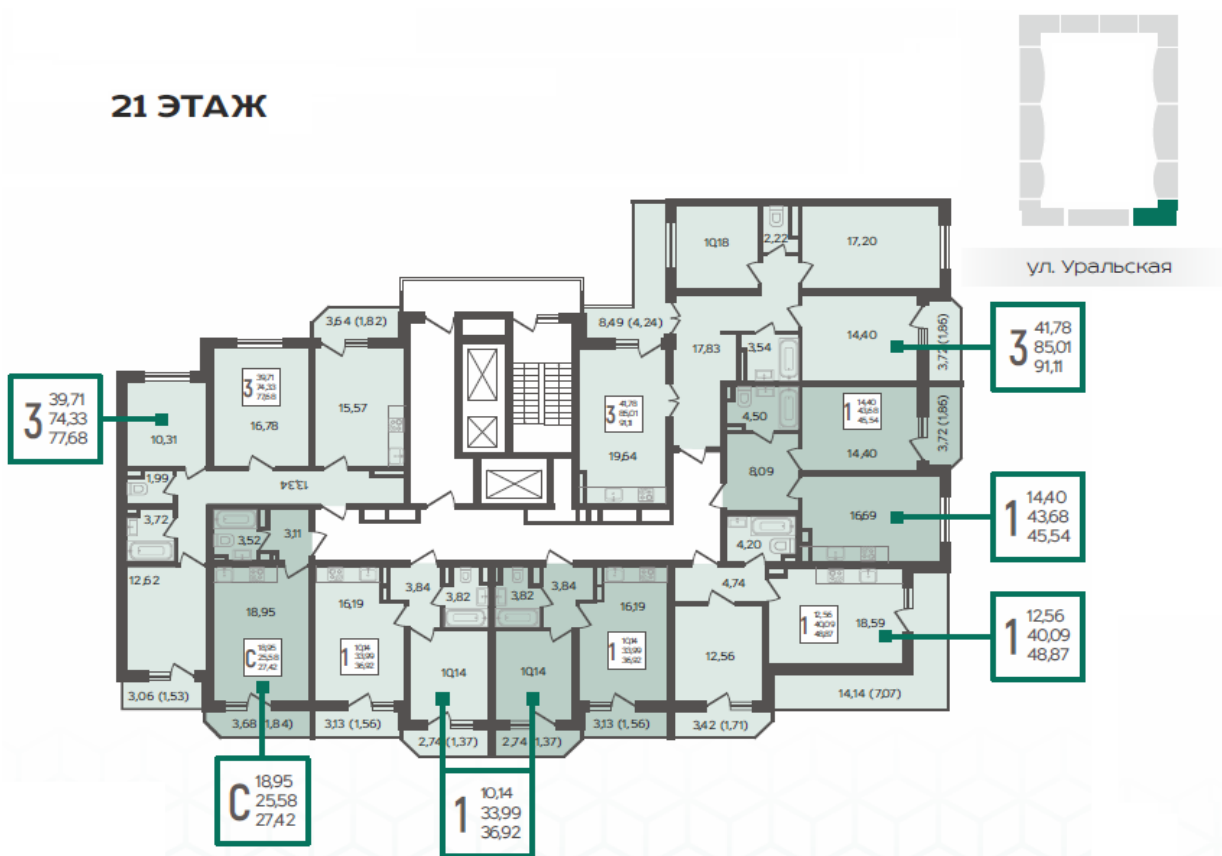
План 21 этажа БС-12 ЖК URAL
